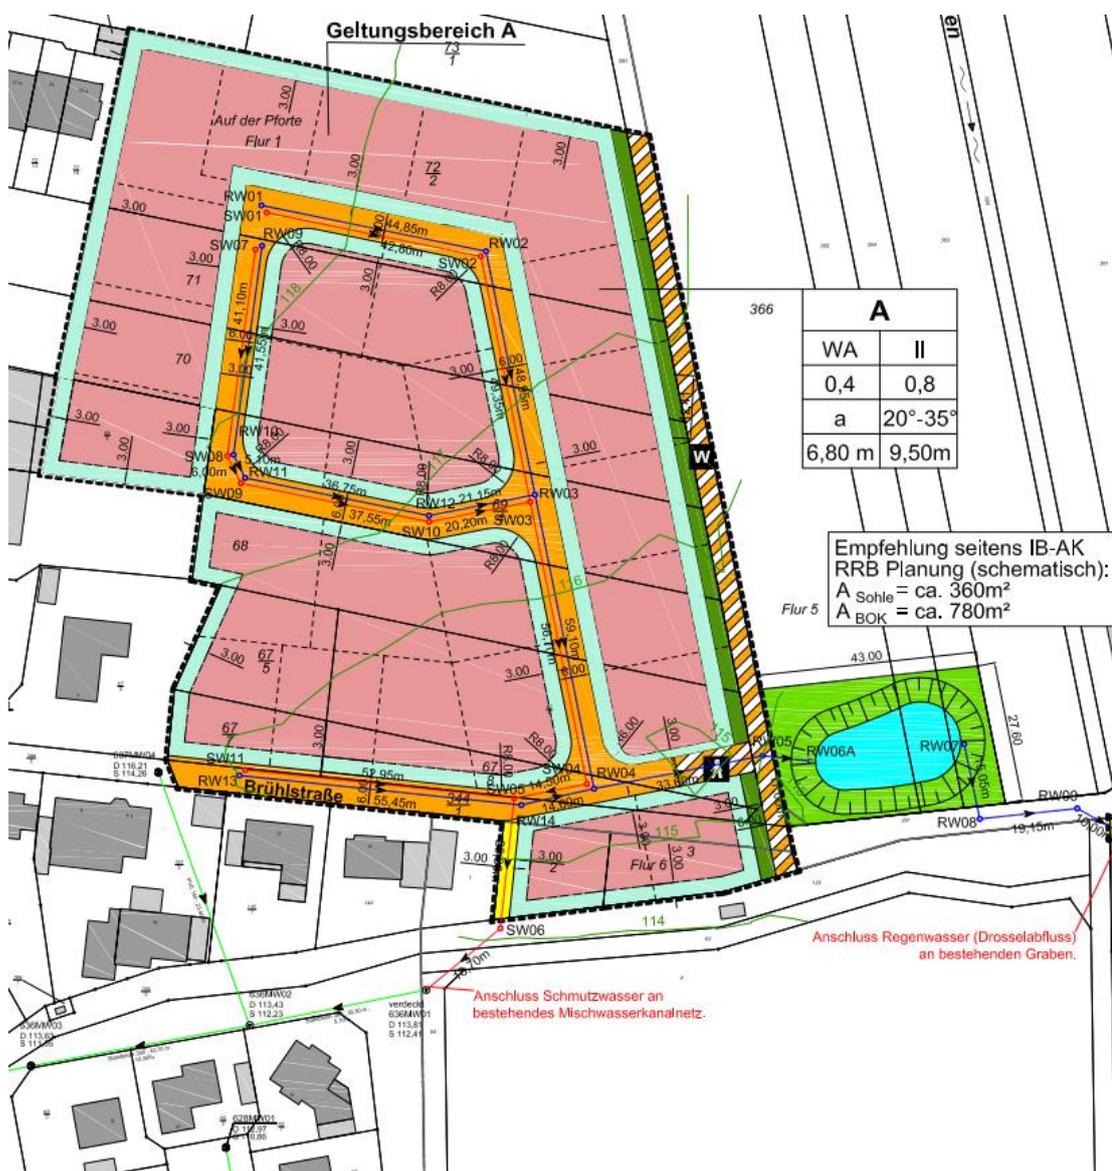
Auszug aus dem Lageplan zur Entwässerungskonzeption, basierend auf dem B-Planentwurf
